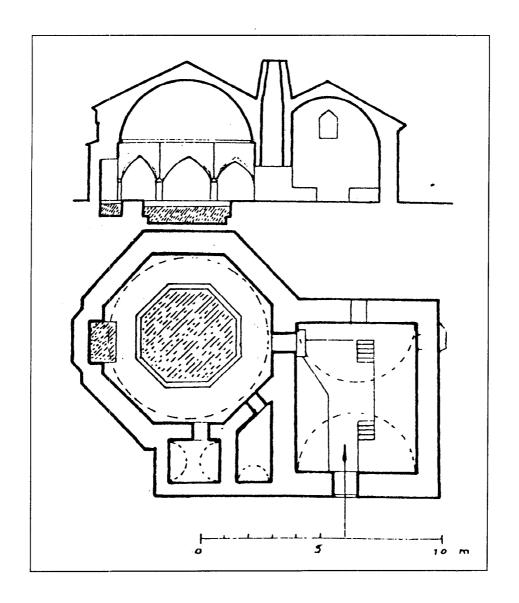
مسقط أفقي لمجمع قلج على باشا بإستانبول (عن : اصلان ابا) .
